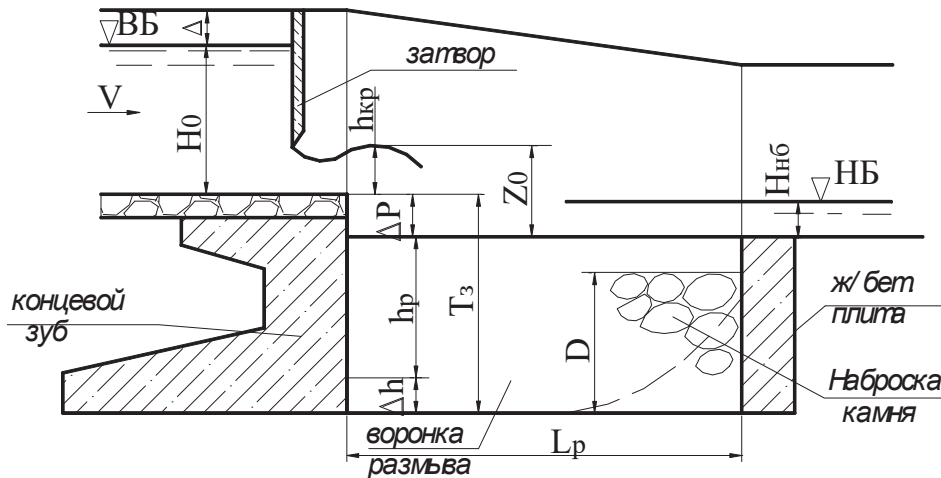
Расчетная схема нижнего бьефа водозаборного сооружения
